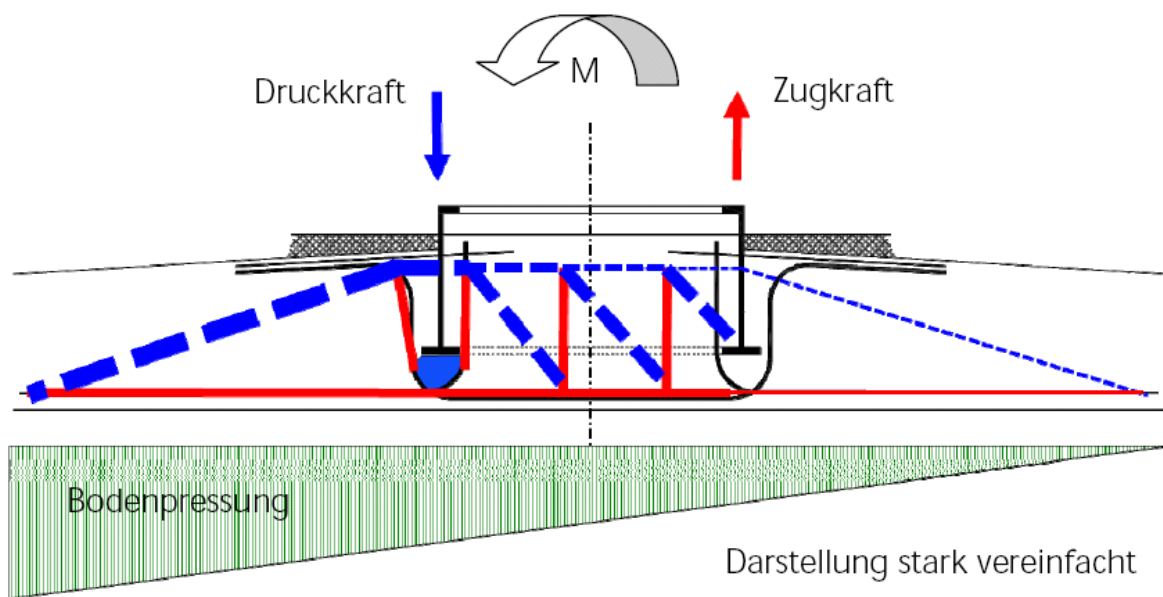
Vereinfachte Darstellung des Lastabtrags mit Einzelflansch [1]
